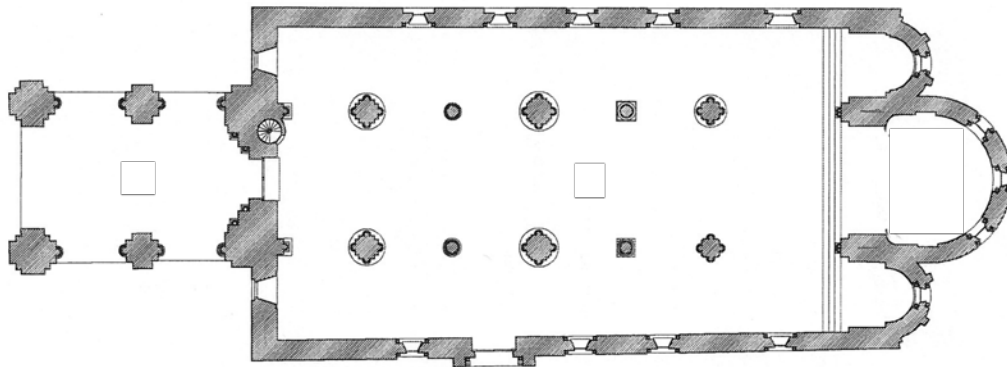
Plano de la catedral de Jaca (hacia 1140)
